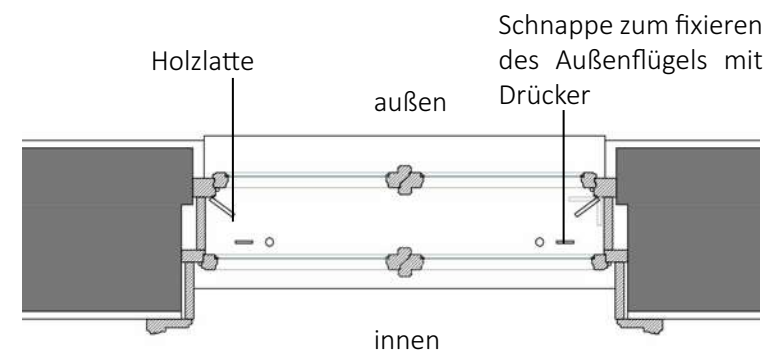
rechts: Längsschnitt durch ein Kastenfenster Typ 1, M=1:20.
